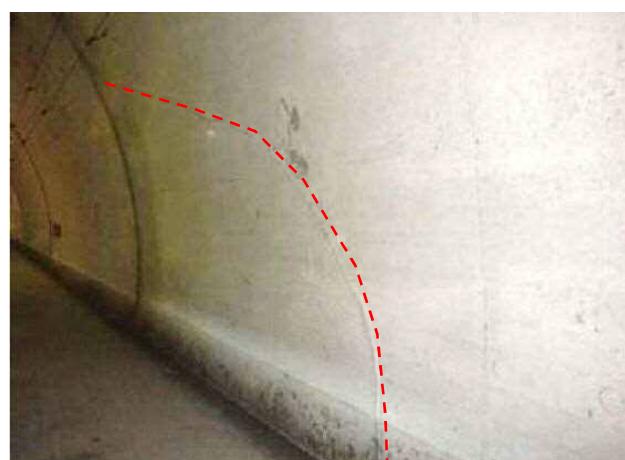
打重ね線に沿って発生したひび割れ
